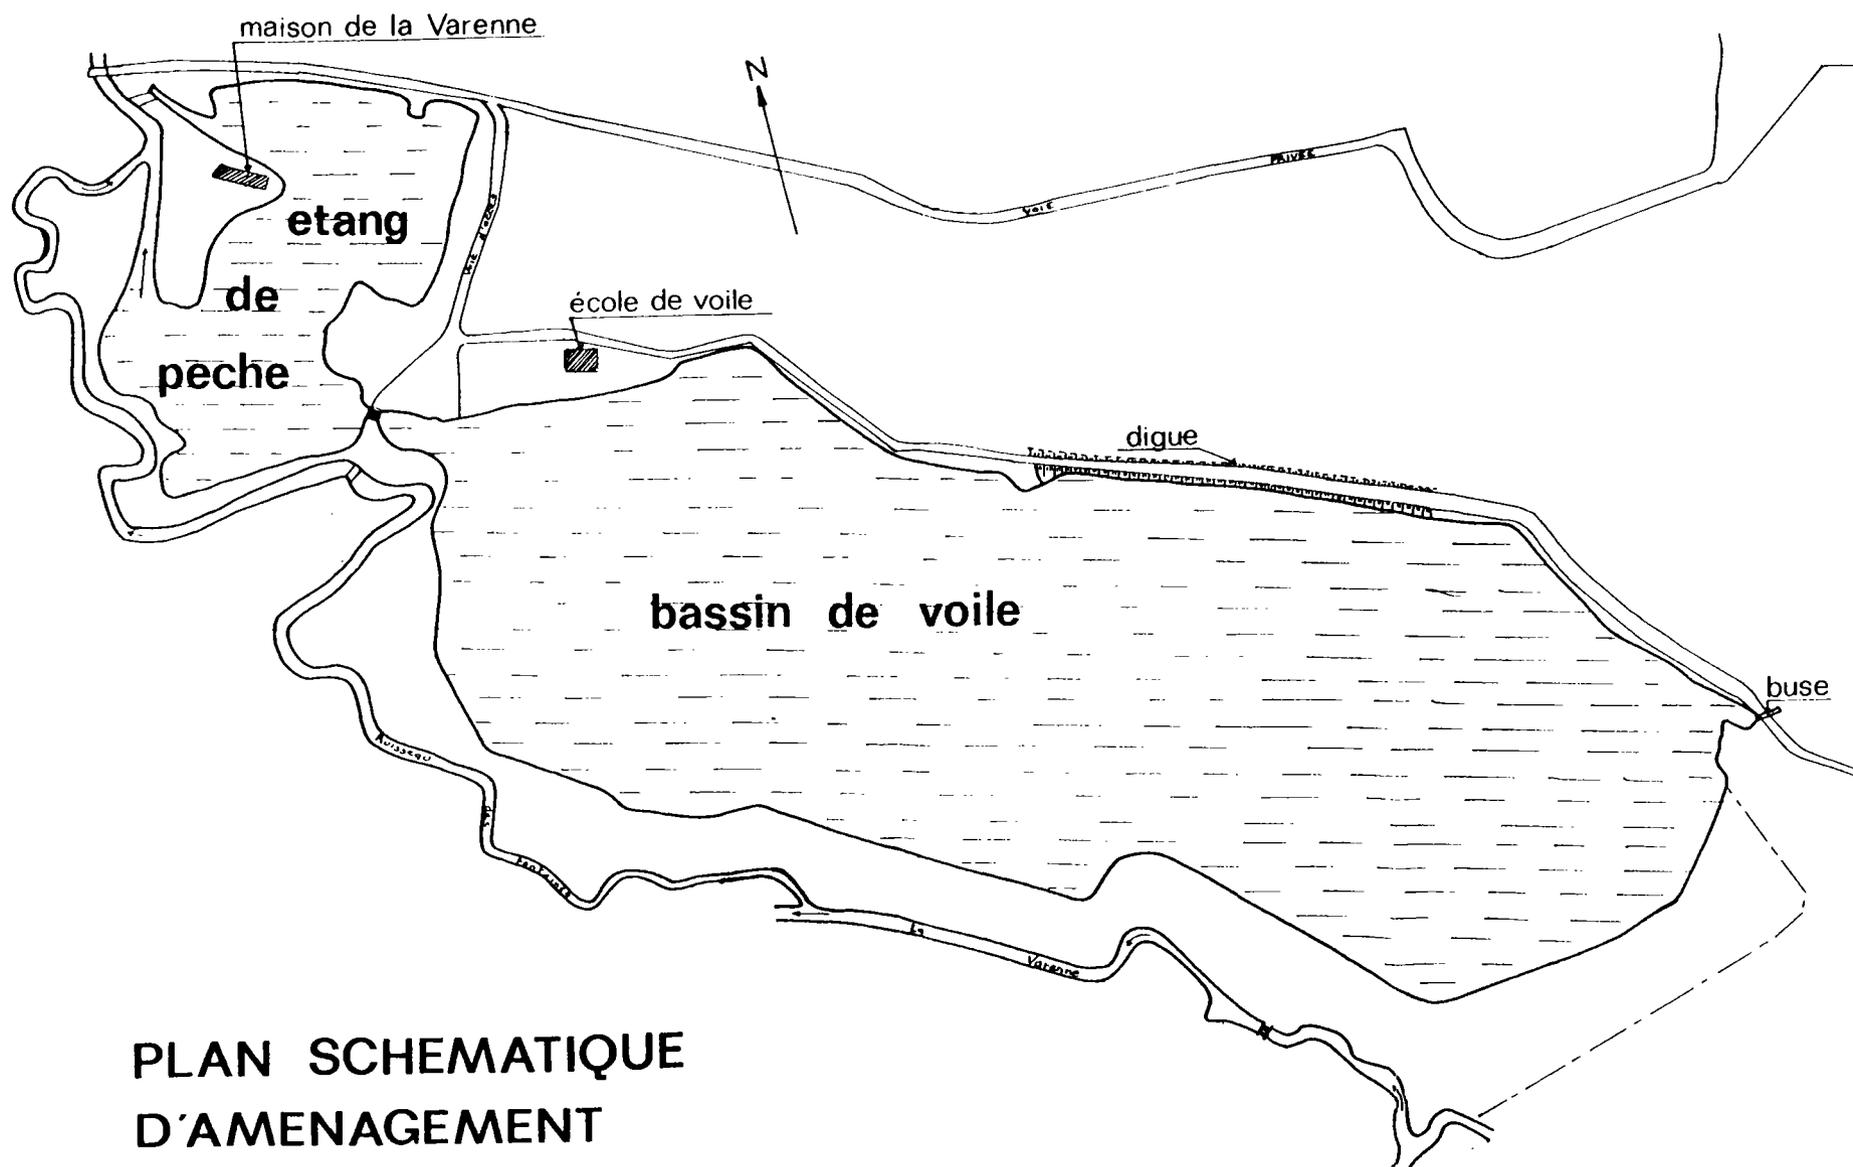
Aménagement du plan d'eau de St Aubin-le-Cauf (76). Situation avant travaux.
